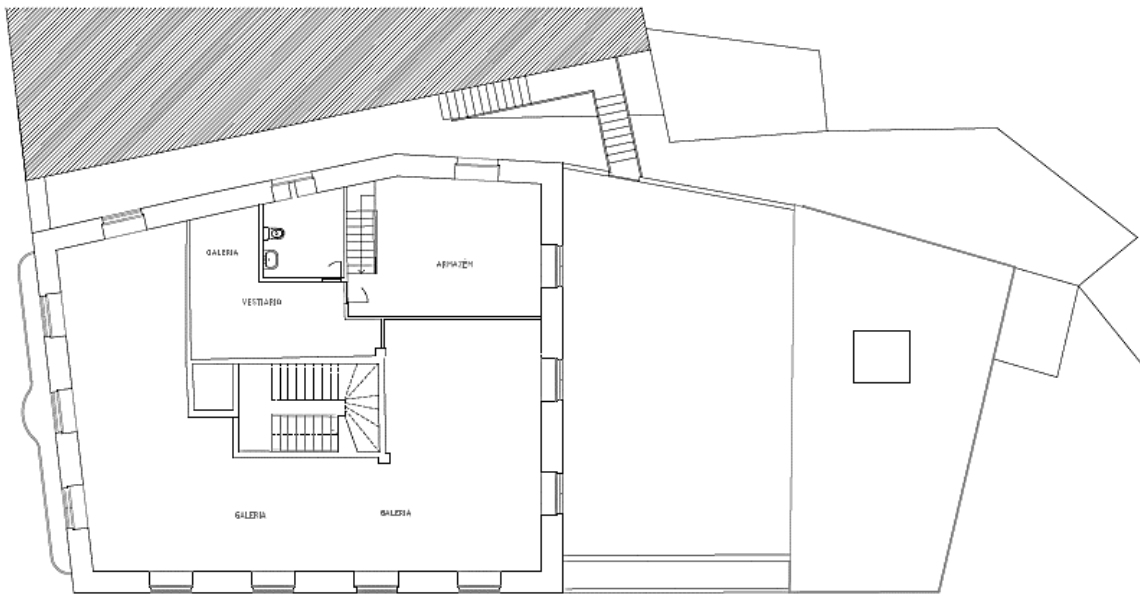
Planta 2 à cota dos arrumos - Esc. 1/200 – Autora do projeto
